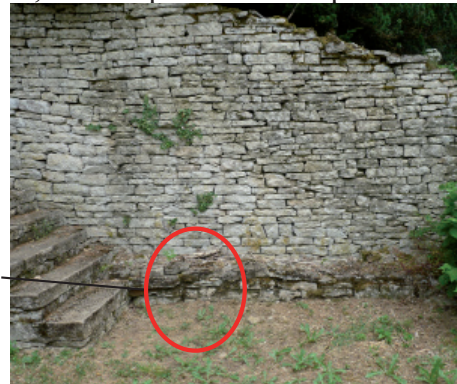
i.1 : vue du banc au pied de l'escalier N°6
